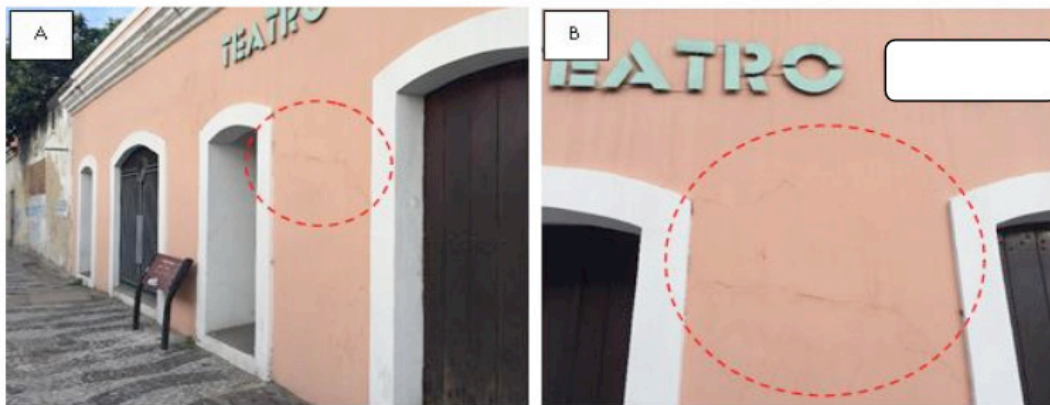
(A) e (B) Fissuras em alvenaria provocadas por movimentação higroscópica.
